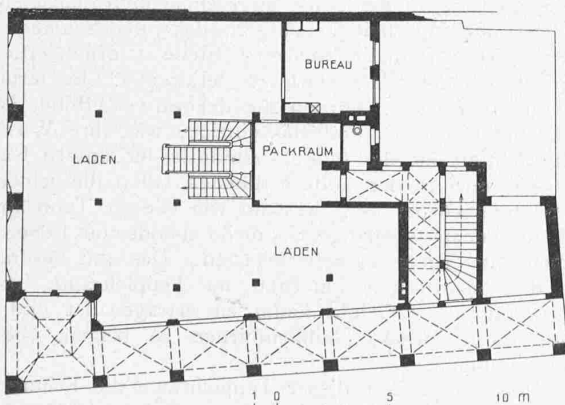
«Rot-Haus». Grundriss vom Erdgeschoss. — 1:300.
